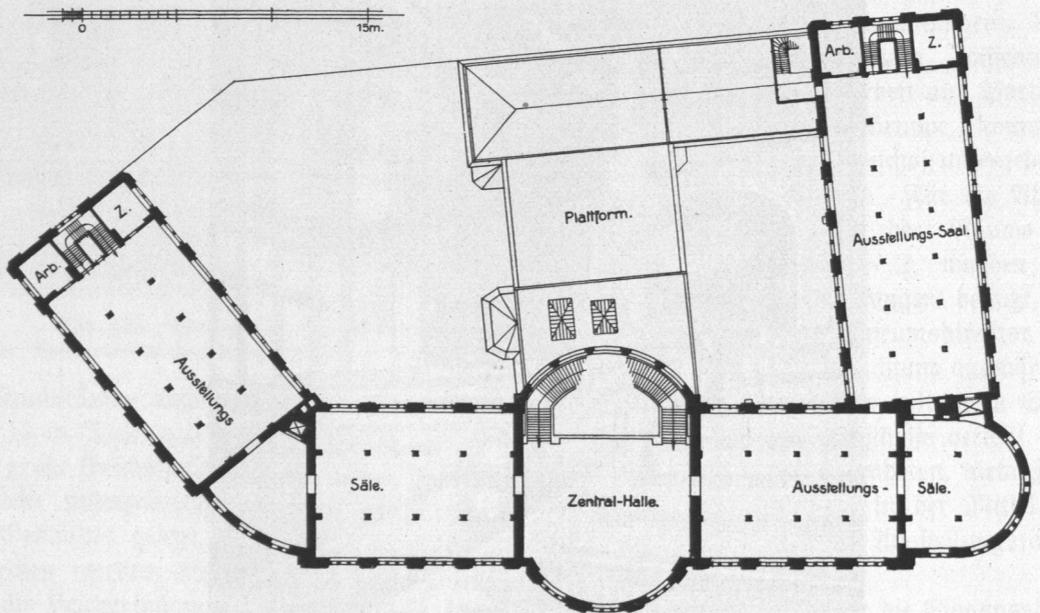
Museum für Völkerkunde, Obergeschoss, Grundriß.
